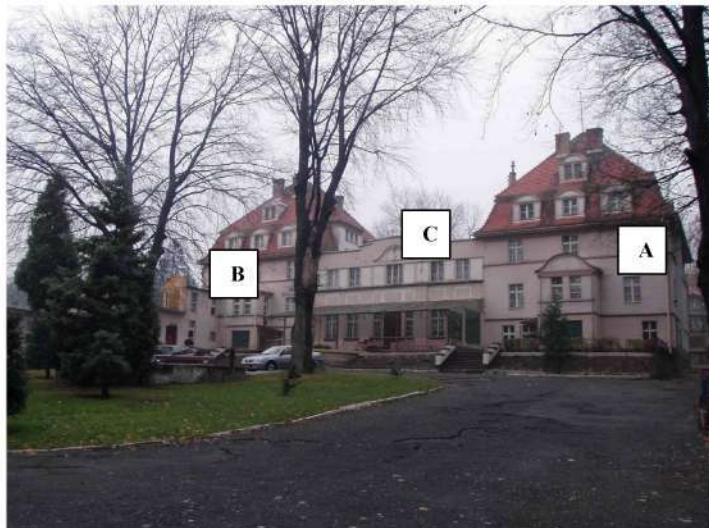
Elewacja wschodnia – budynek A, B, C
